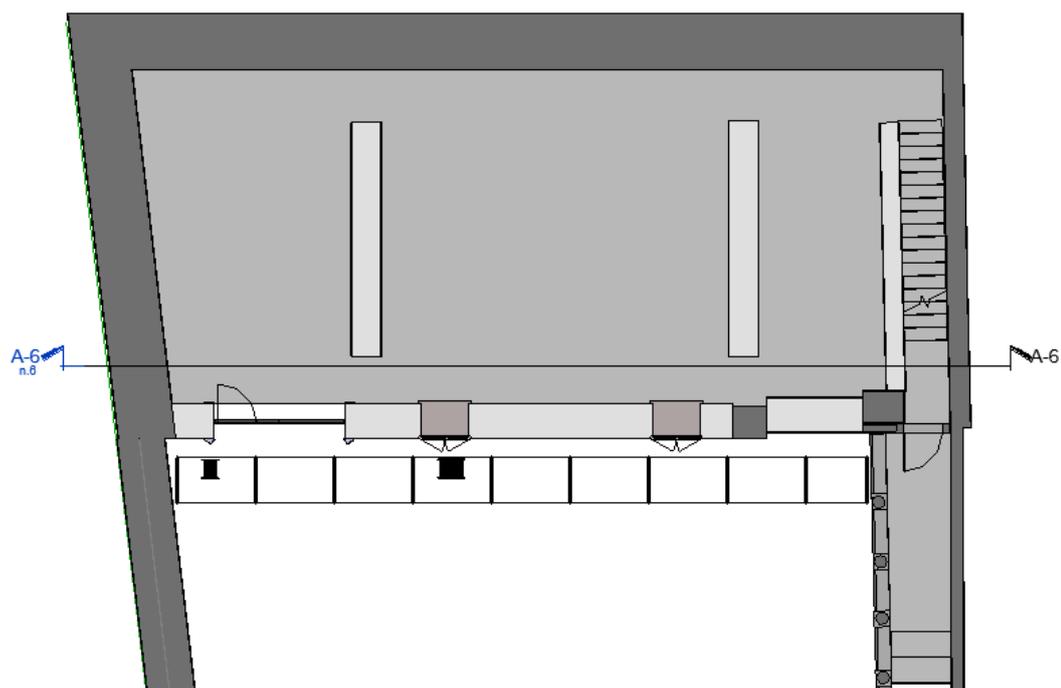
Vista di progetto inerente alla demolizione delle partizioni interne al piano terra
